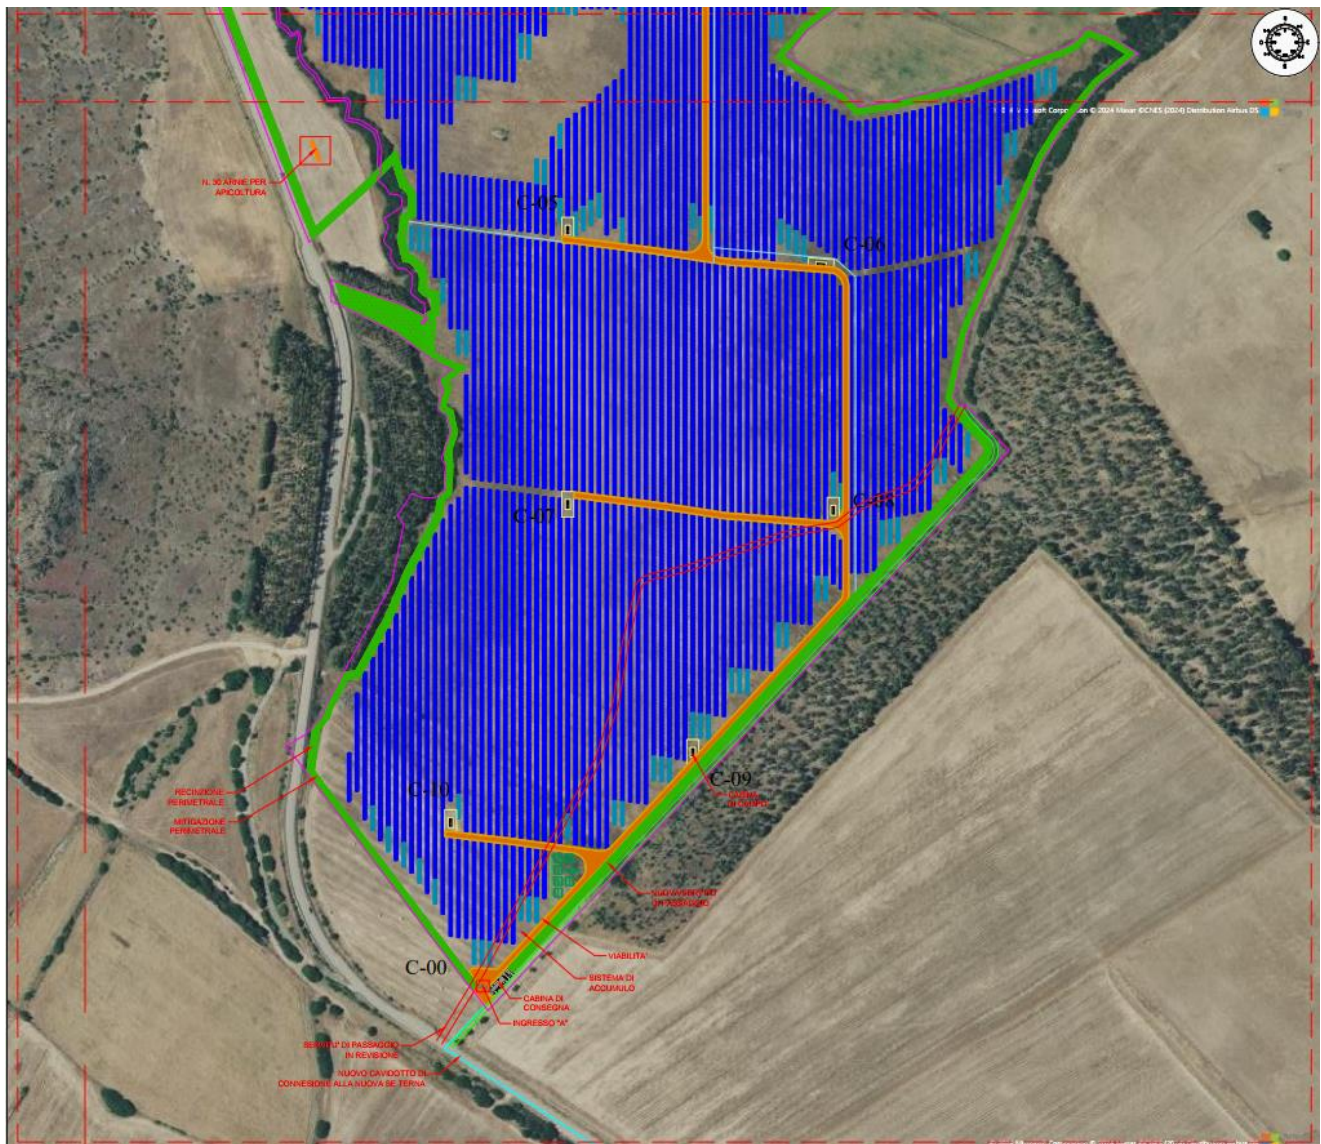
Planimetria, aree impianto agrivoltaico e fasce di mitigazione area sud
